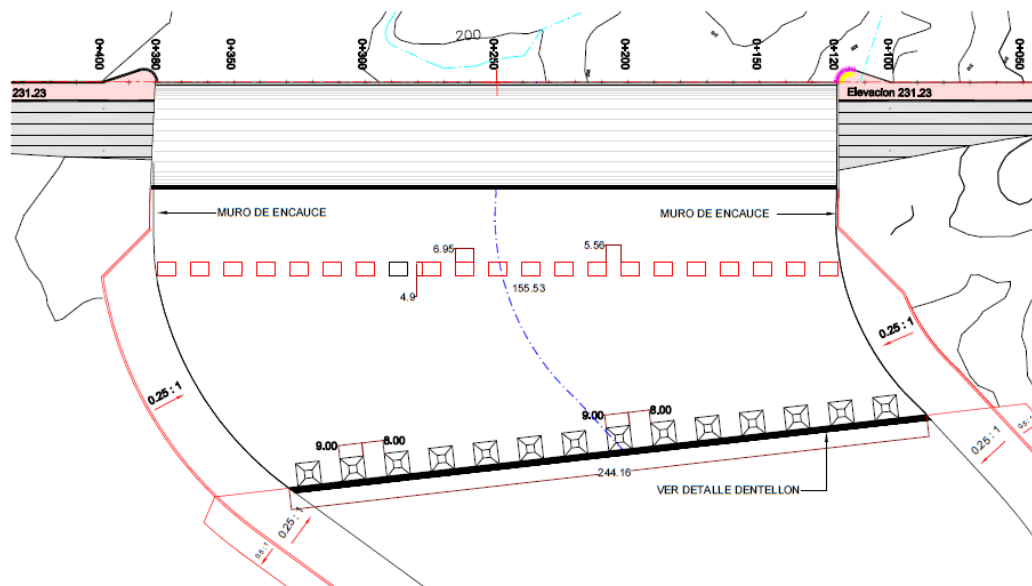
Propuesta final en planta de la obra de excedencias en prototipo
